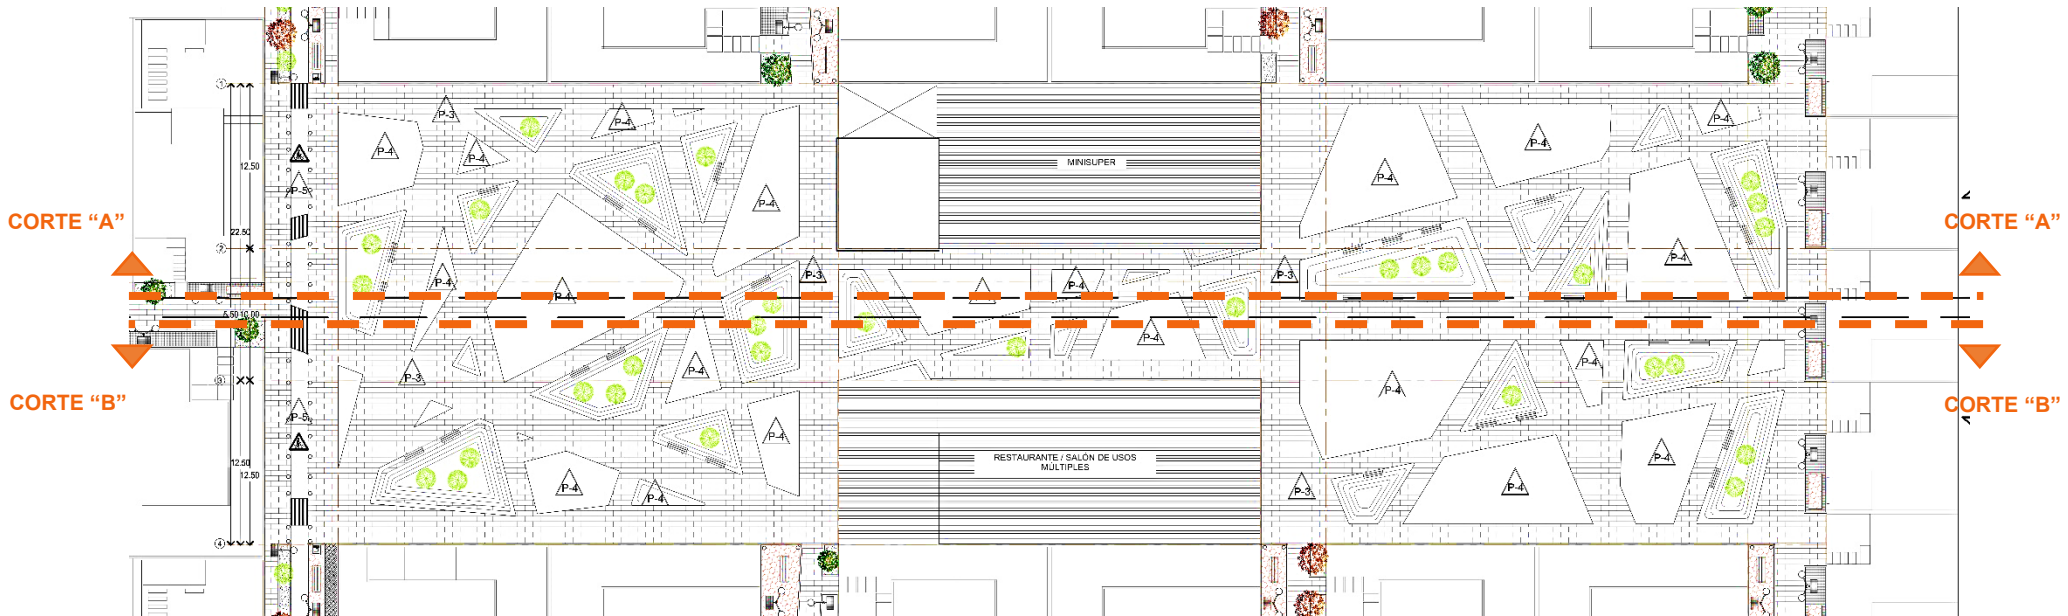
Planta arquitectónica de la plaza principal del conjunto. Plano de elaboración propia, 2017.
